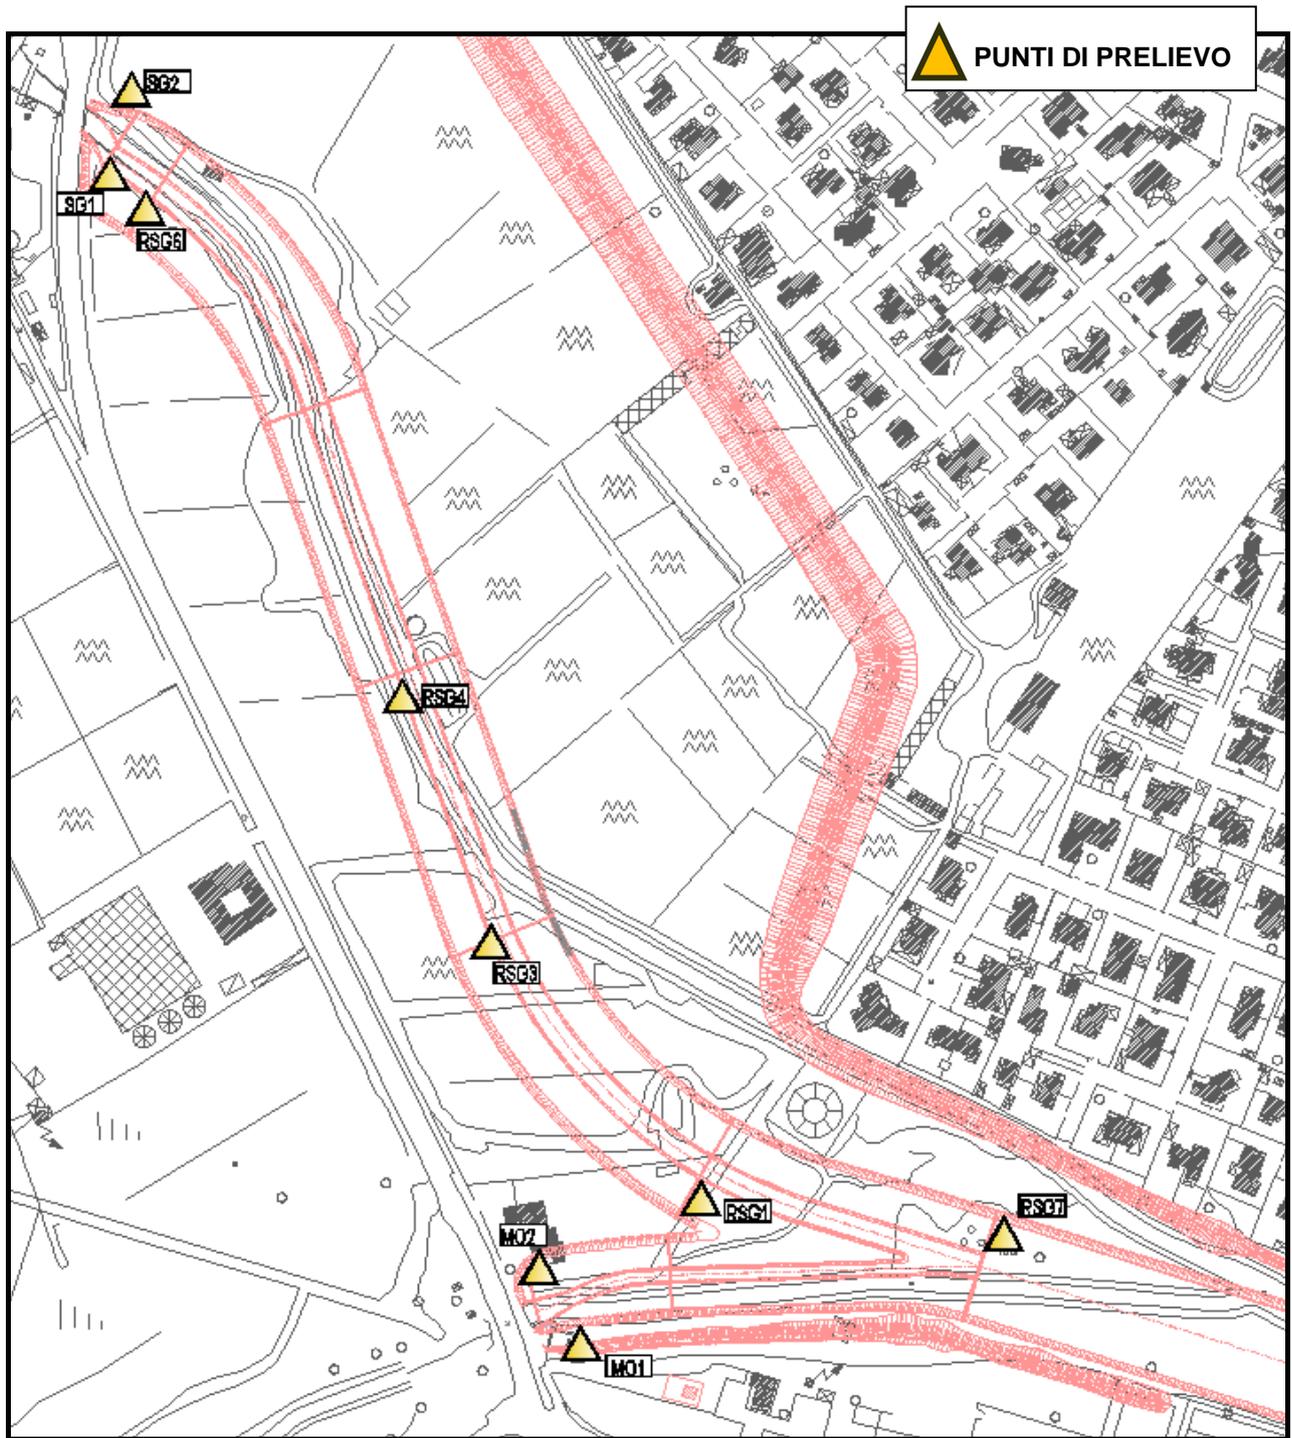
Stralcio dell'elaborato 7.2. Planimetria indagini ambientali.
